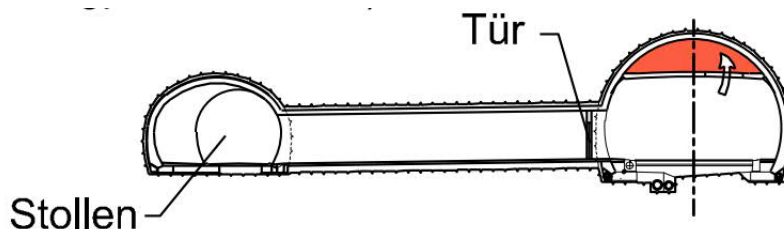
Einröhriger Gegenverkehrstunnel mit Fahrbahn und Rettungsweg
